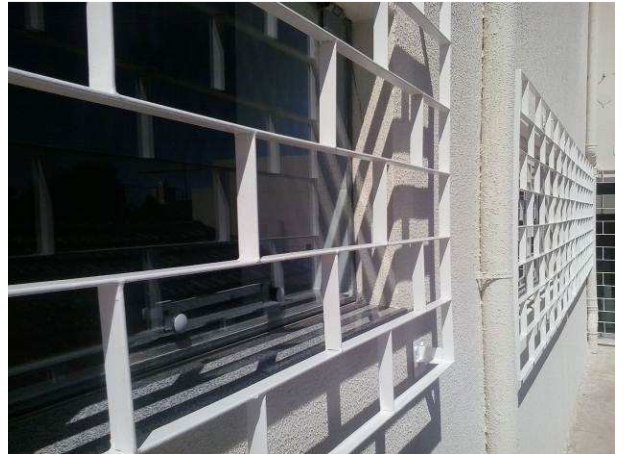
C: Pintura nas grades das janelas do primeiro pavimento
